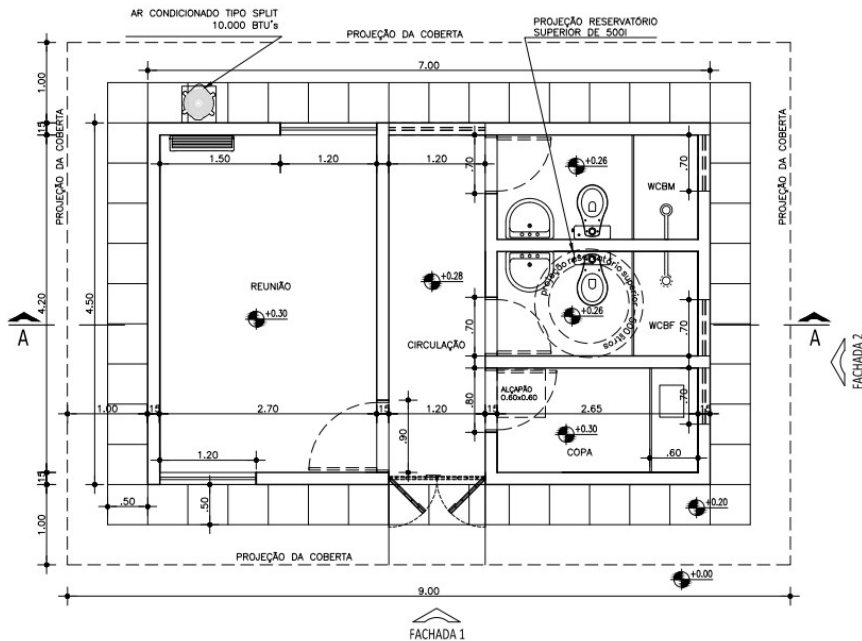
Edificação de apoio padrão para acessantes - Planta Baixa
